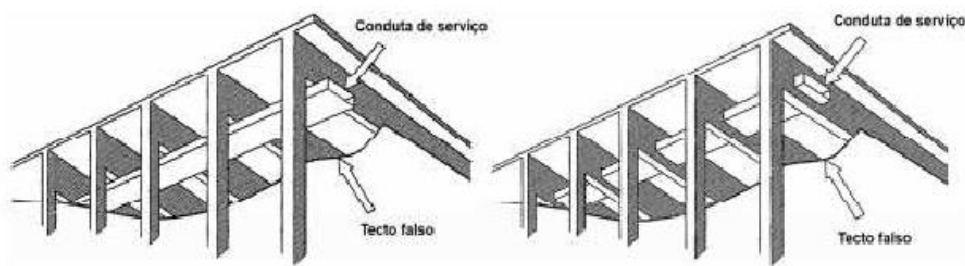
Zonas de passagem de instalações técnicas, adaptado de Mansur et al.
